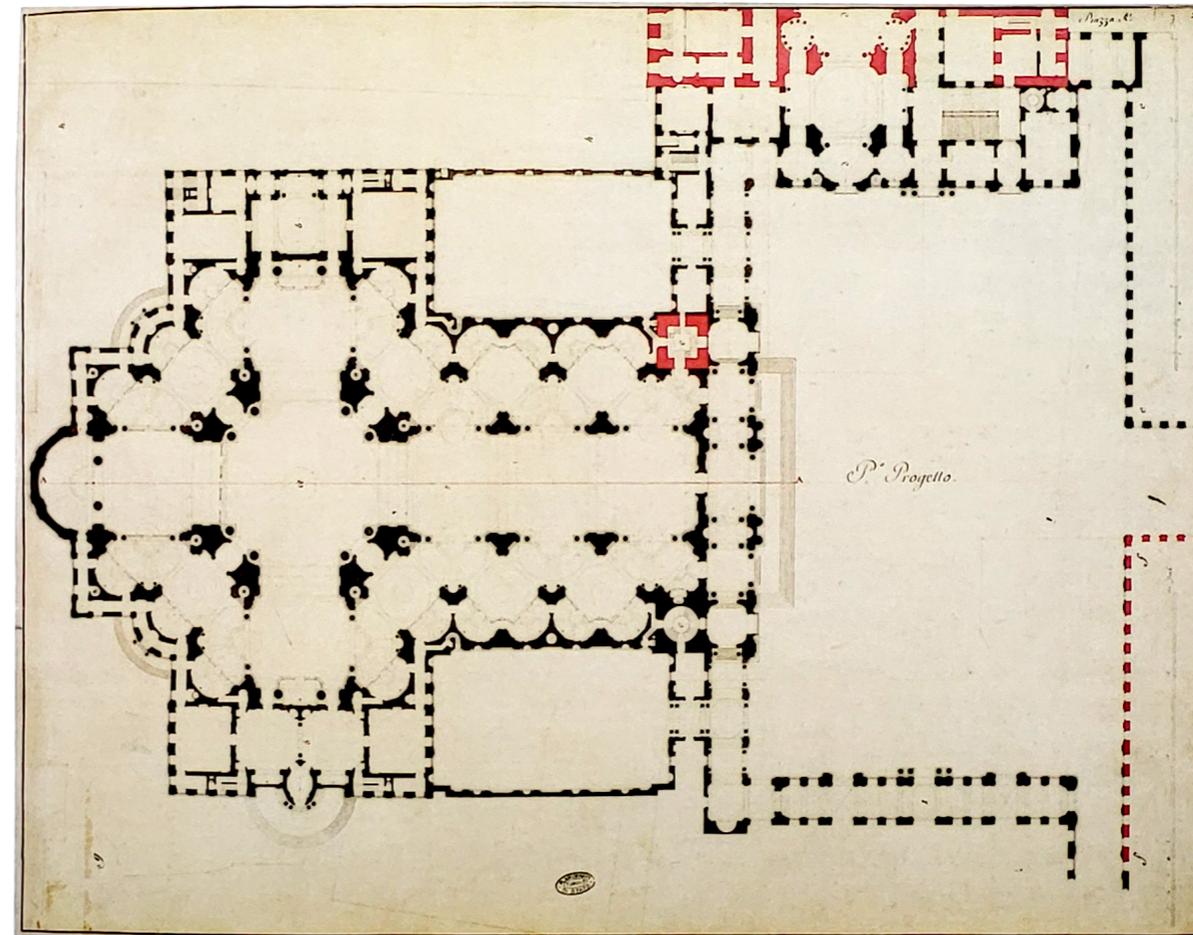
Primo progetto del Duomo di Torino di Benedetto Alfieri, pianta
